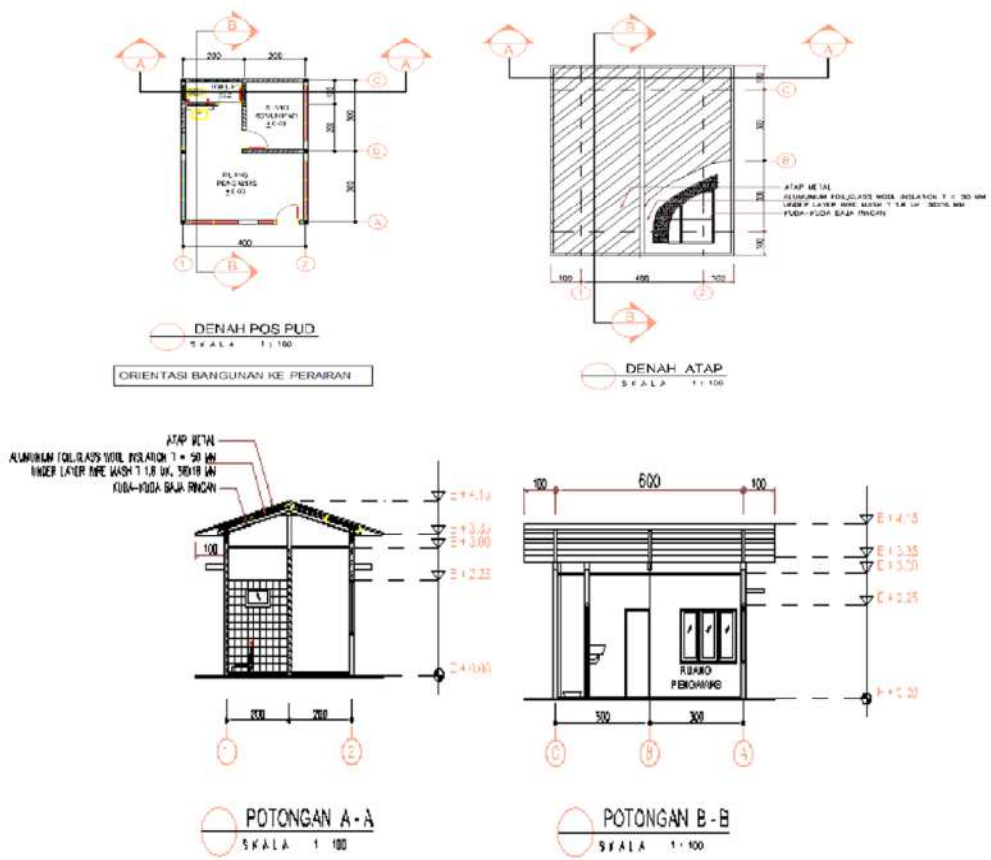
Denah Orientasi Bangunan Pengawasan ke perairan
